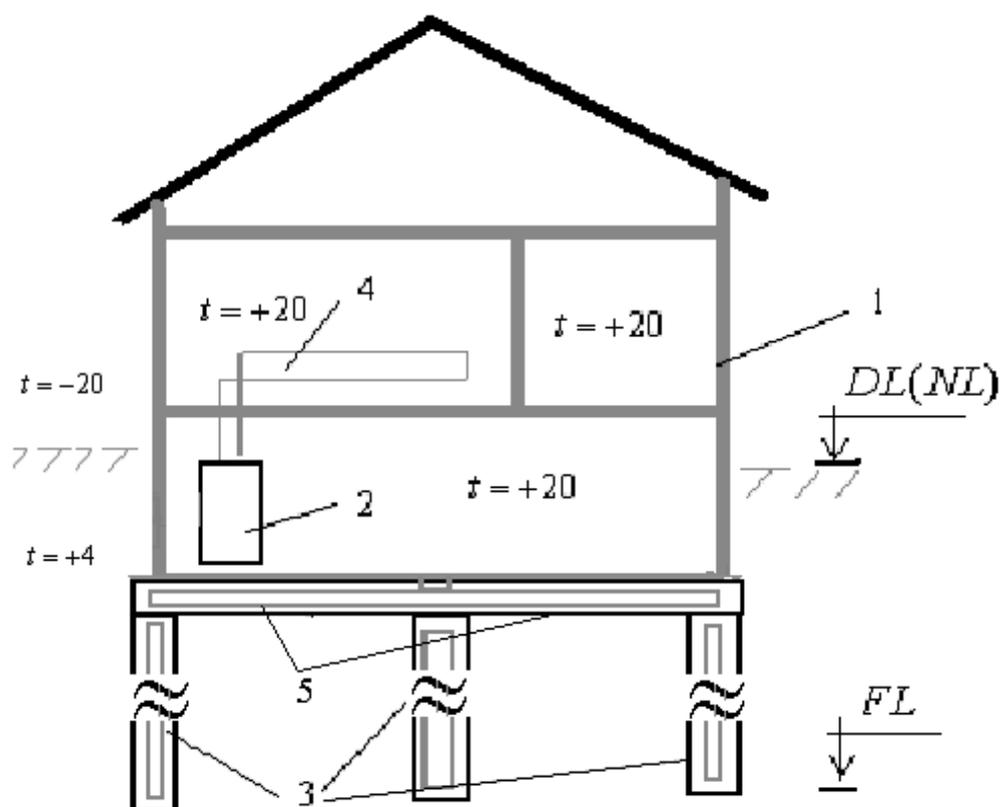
Вариант размещения коллектора в фундаментах здания (схема).
